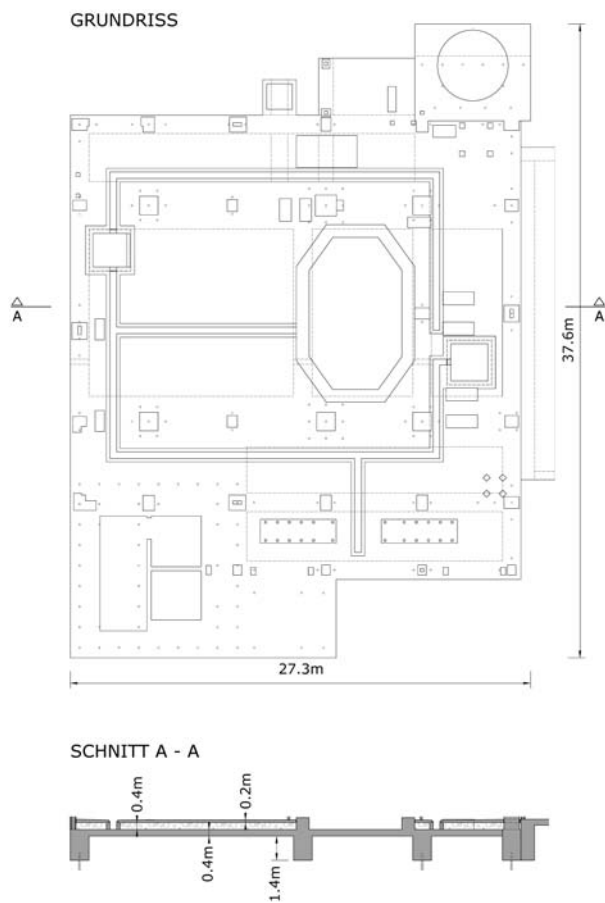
Papierfabrik, Fundierung Laugenkessel (Grundriss und Schnitt)
